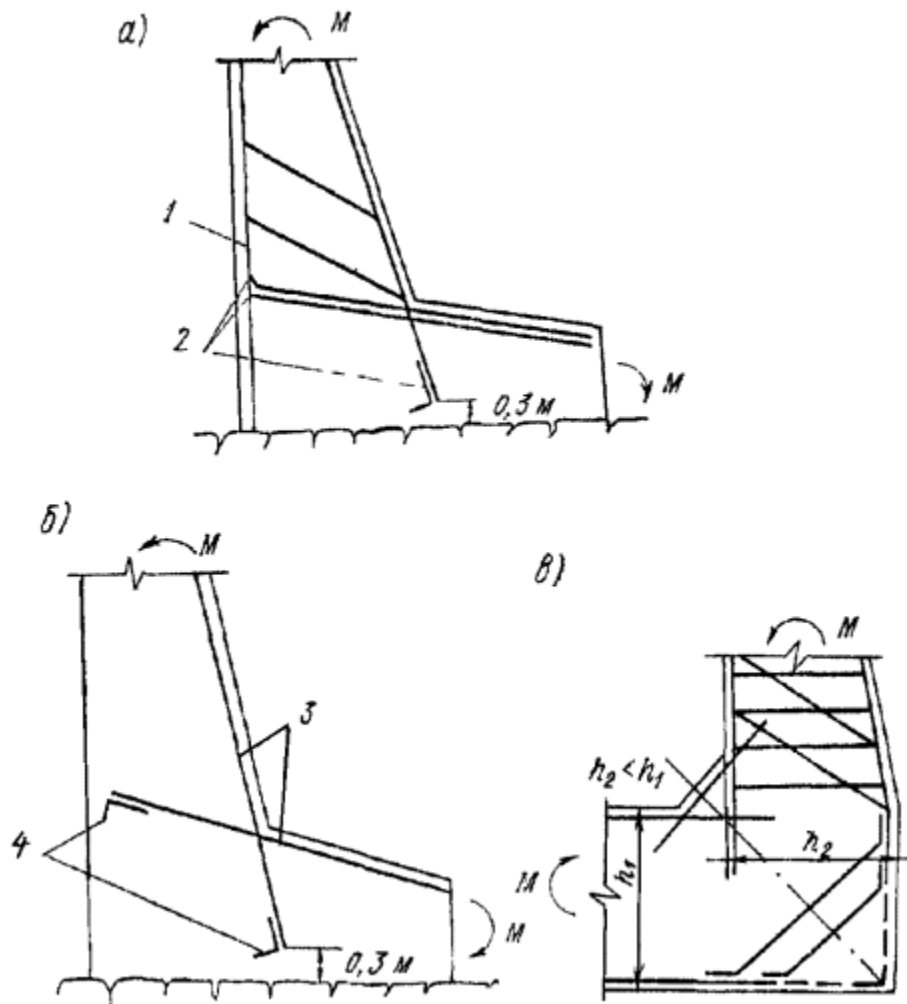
Схемы армирования угловых сопряжений железобетонных конструкций
